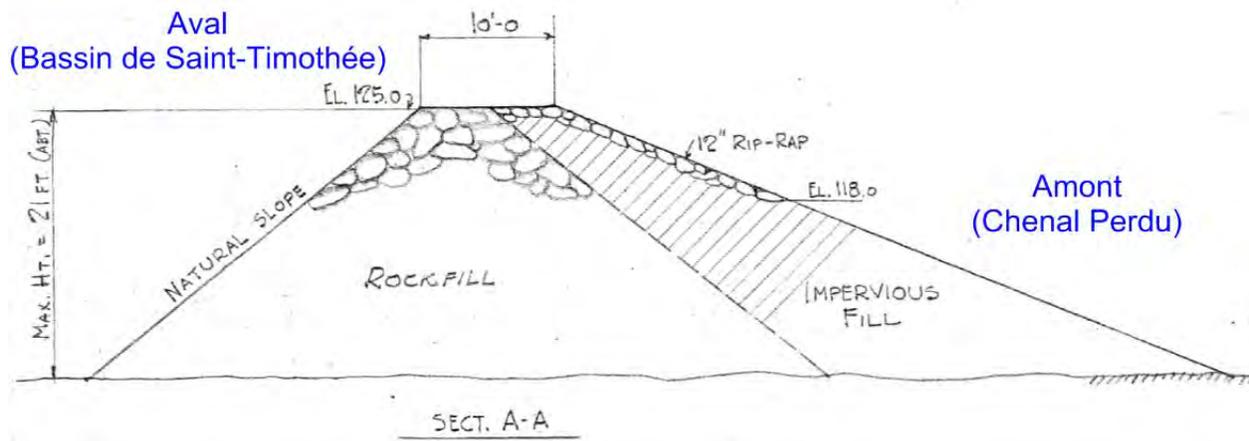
STRCT1 – Coupe type de l'ouvrage en remblai de 1941
